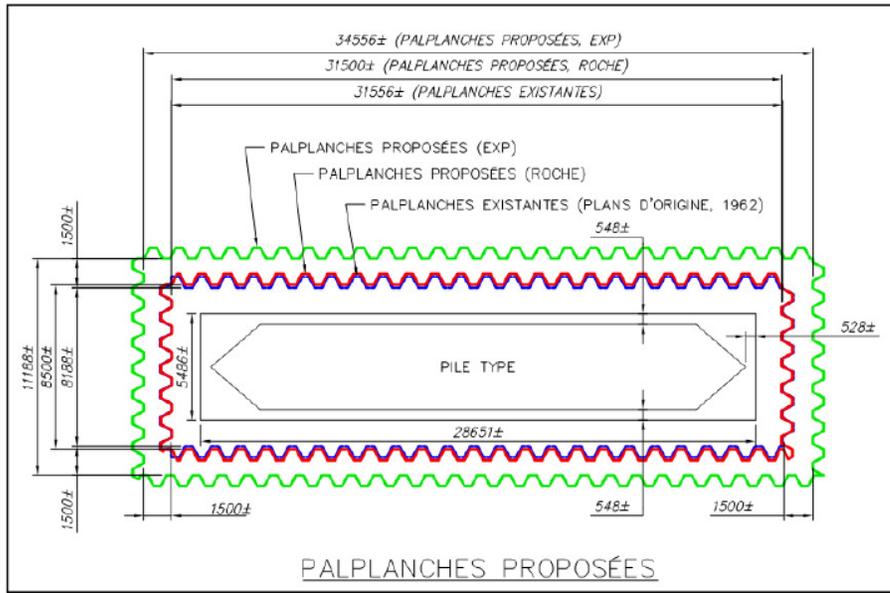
Positionnement proposé des palplanches autour des piles du pont Charles-De Gaulle
